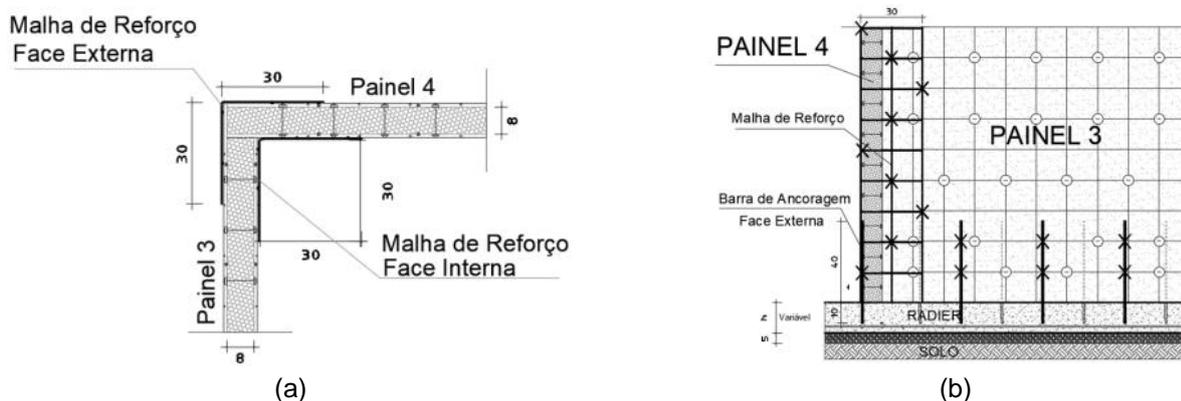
Detalhe ligação entre painéis: (a) vista em planta, e (b) vista lateral
